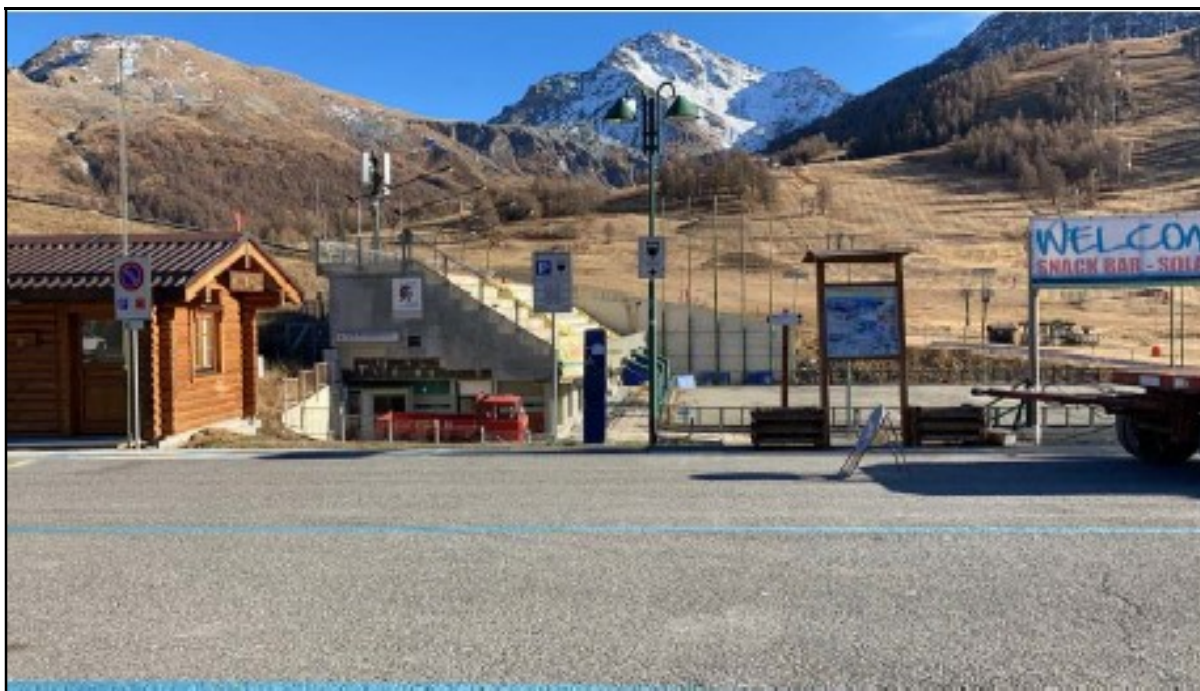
Immagine frontale oggetto della variante strutturale del PRGC vista dal piazzale Kandahar,
